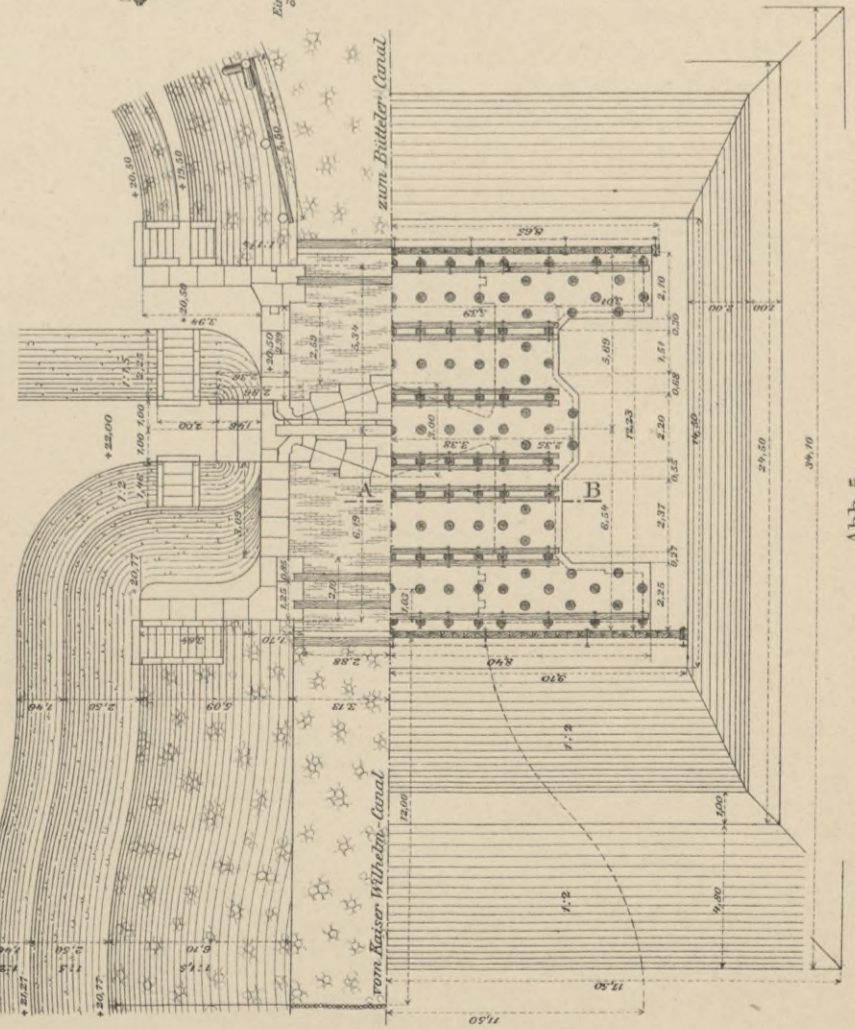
Grundriss des Fundaments und der Baugrube. 1:250.
